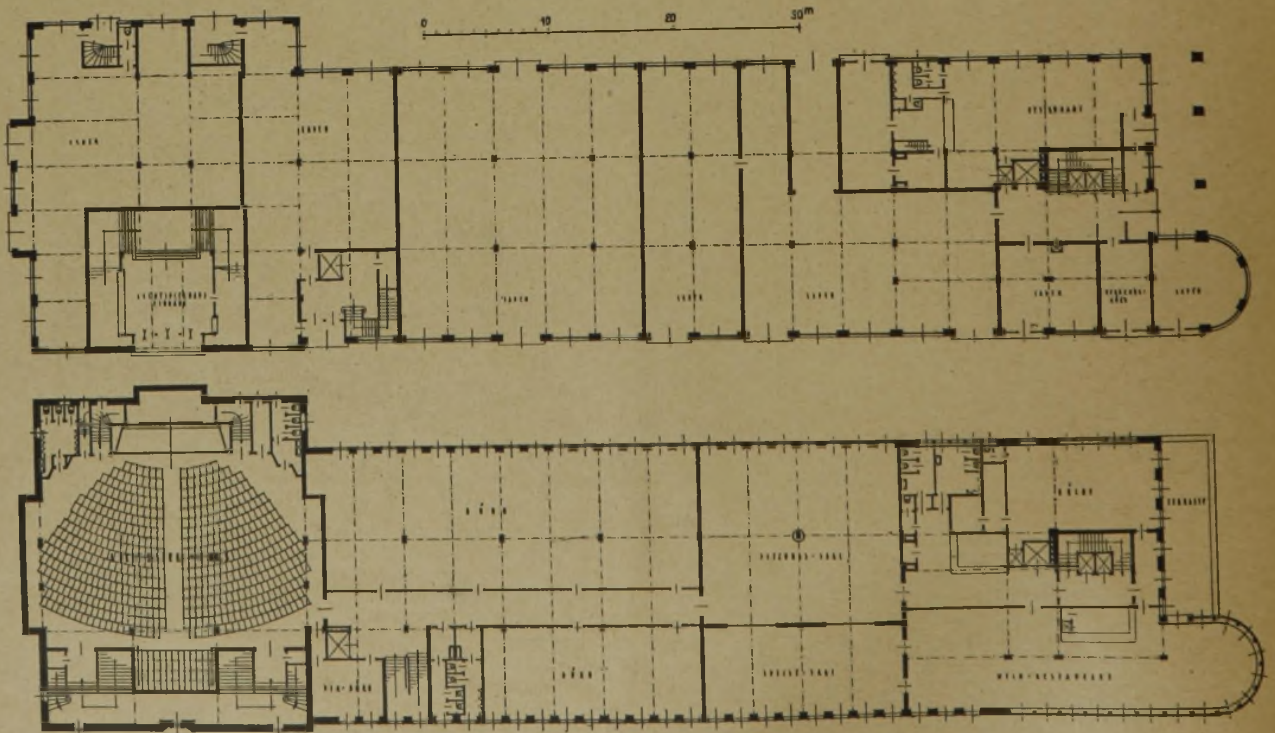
u. 9. Grundriß. Erdgeschoß und I. Obergeschoß. (1 : 600.)
